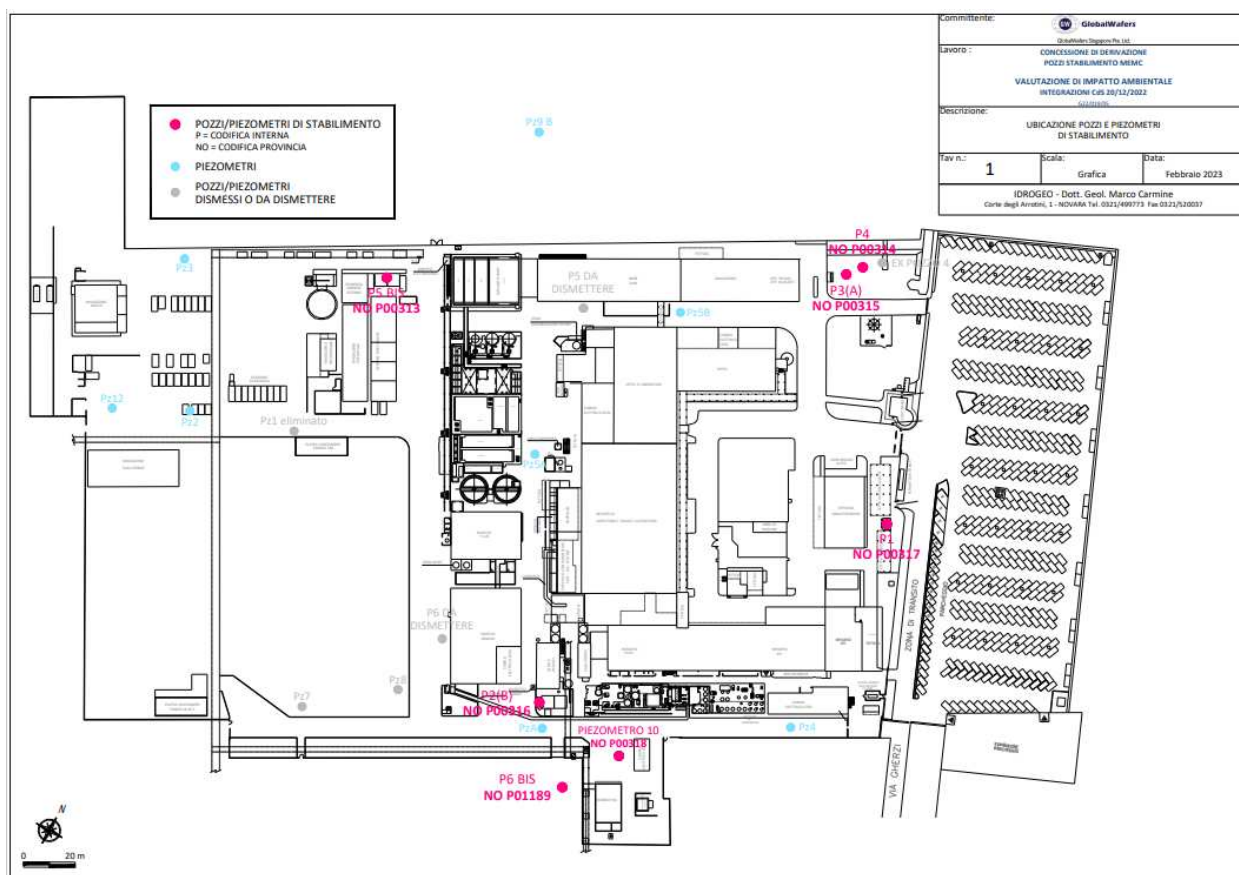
Ubicazione pozzi e piezometri di stabilimento (tavola 1, febbraio 2023)
